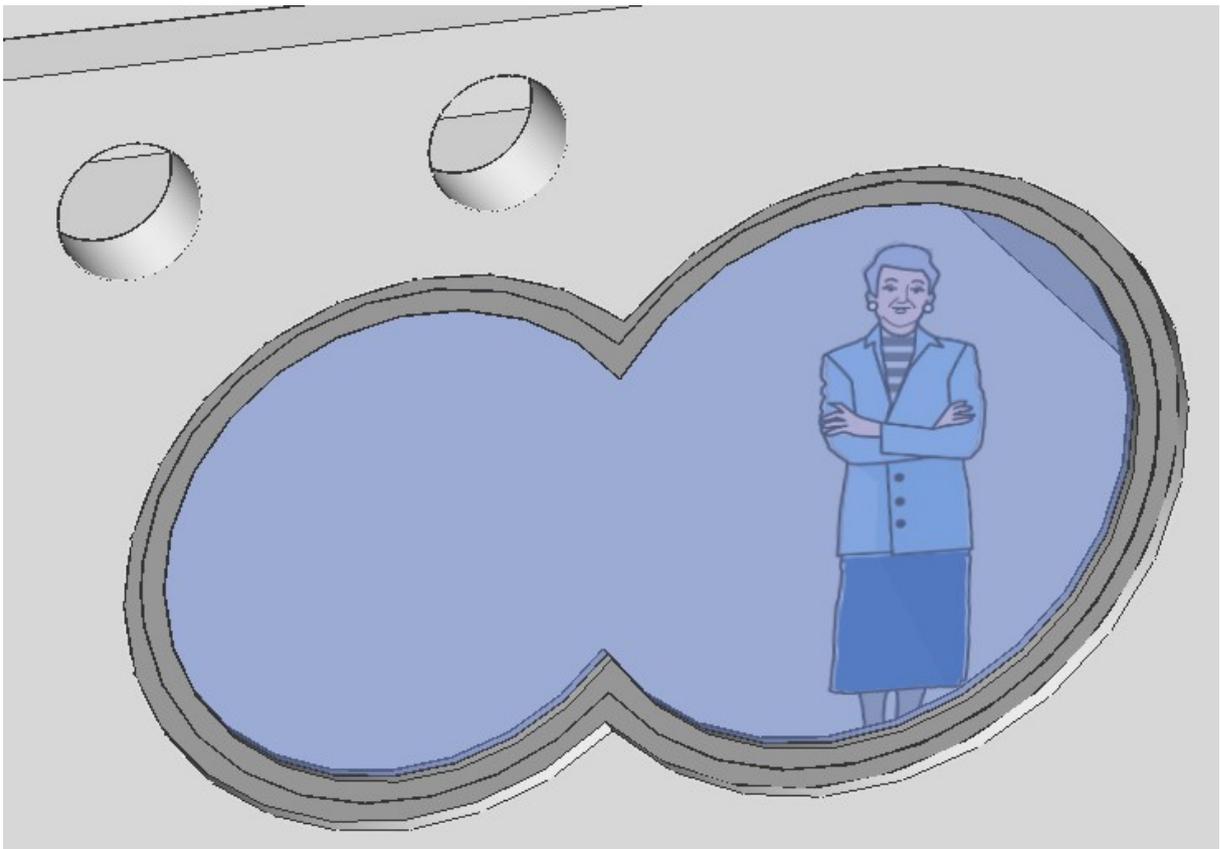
Öffnungen können beliebige Formen aufweisen.
